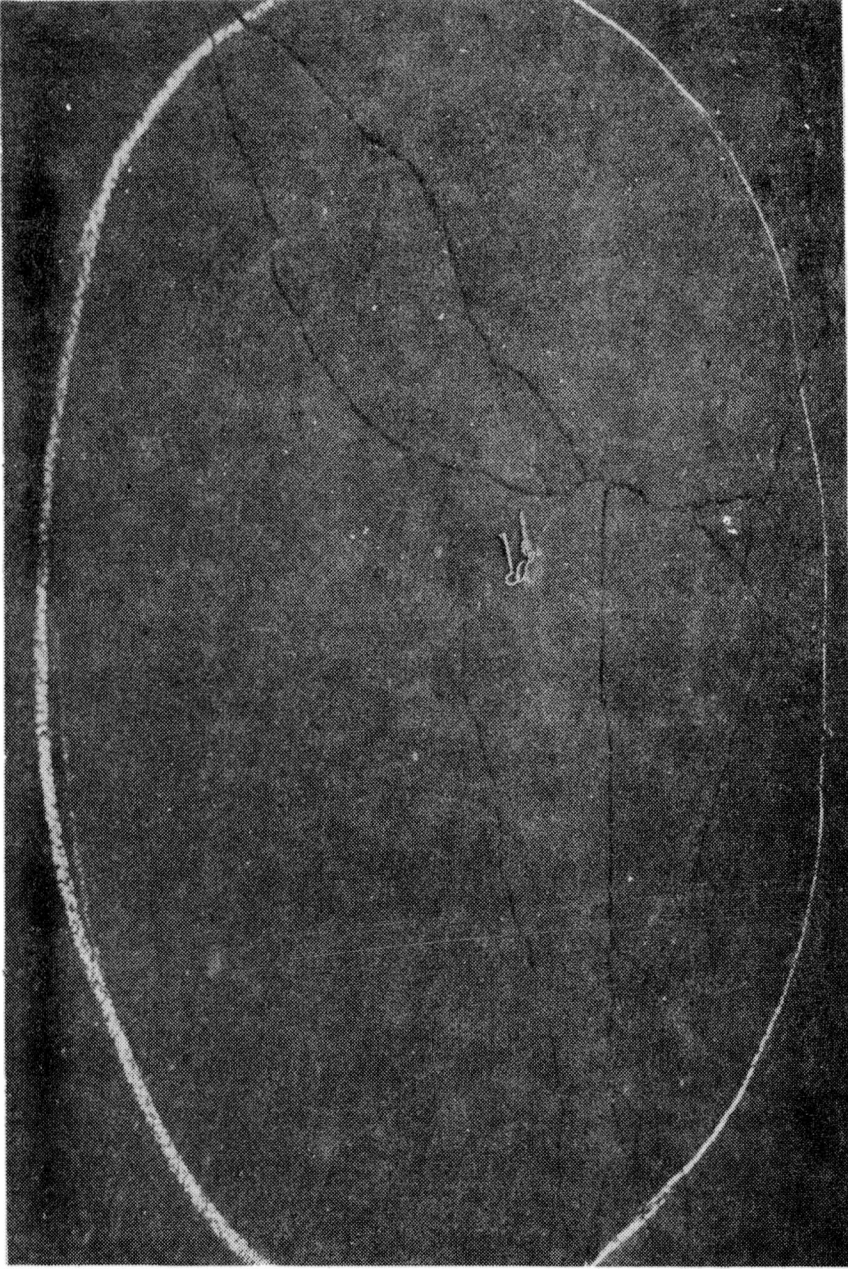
Fisuras debidas a la contracción de la carpeta
